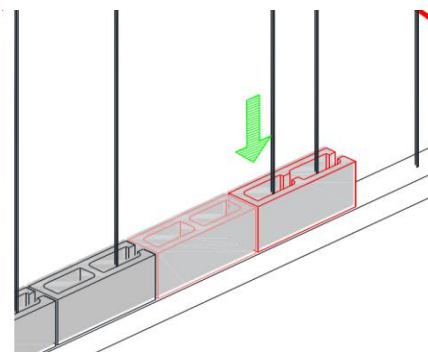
Pieza open end C con acero vertical junto. Fuente del autor
